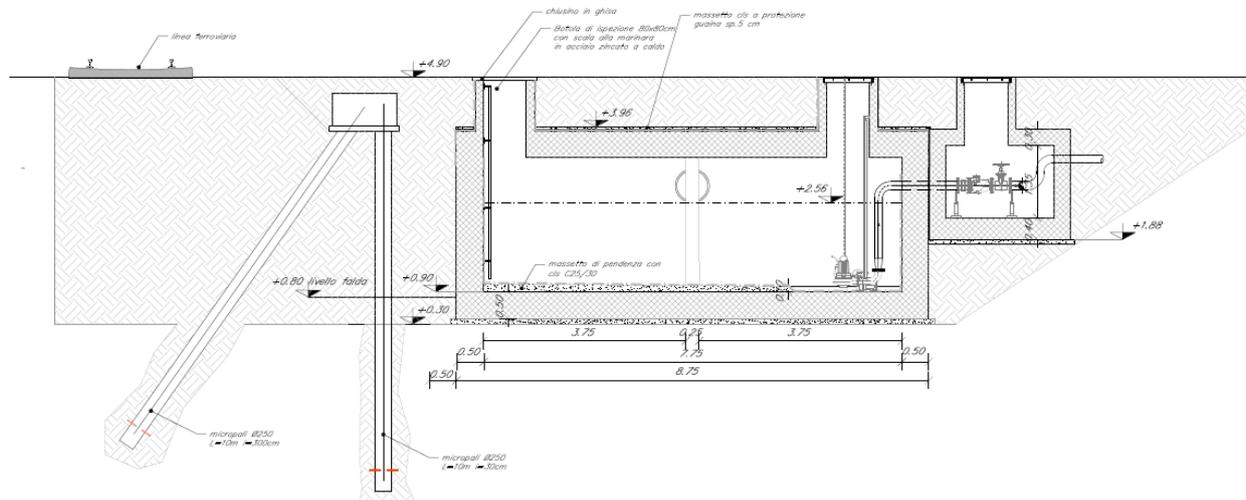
Sezione vasca di laminazione con impianto di sollevamento
